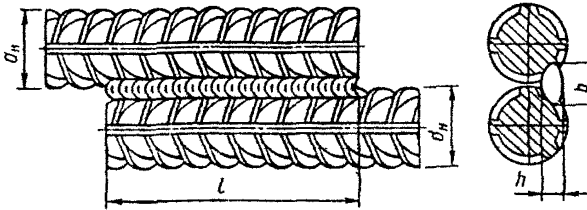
Конструкция стыкового соединения горизонтальных и вертикальных стержней, выполненных внахлестку (тип С23-Рэ). До сварки стр. 170, после сварки стр. 171
